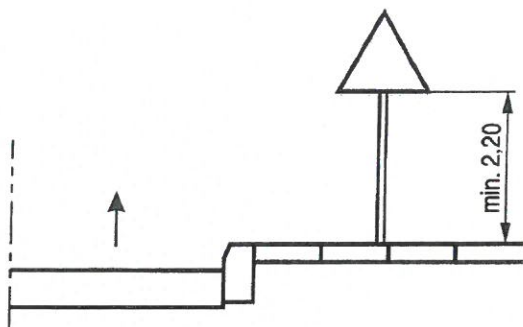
Odległość znaku od krawędzi jezdni na drodze
